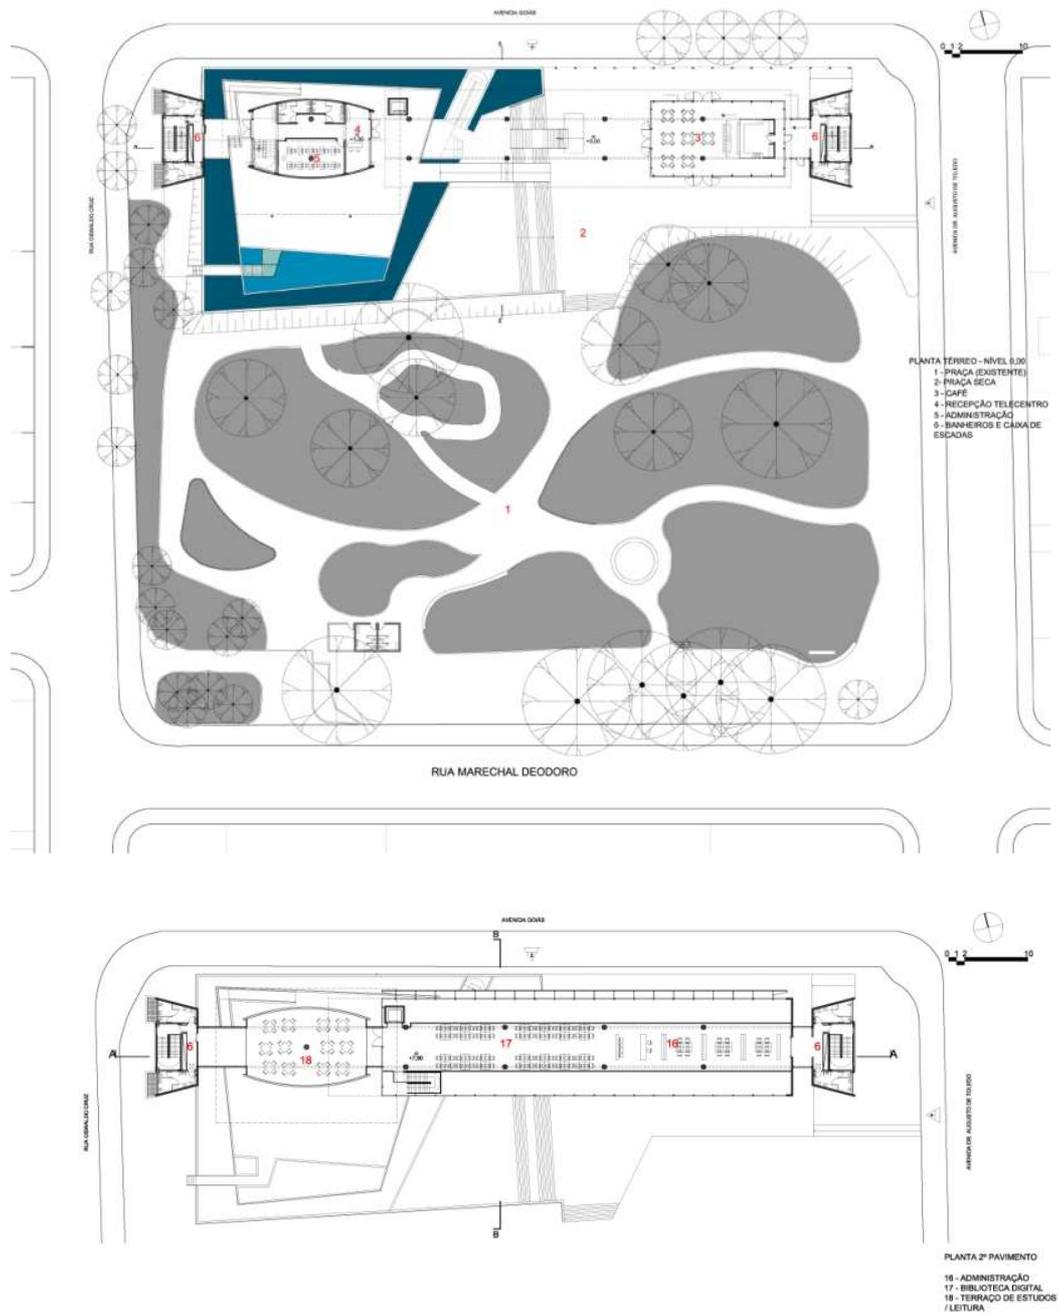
e 3.2 Implantação e Plantas de um pavimento.
